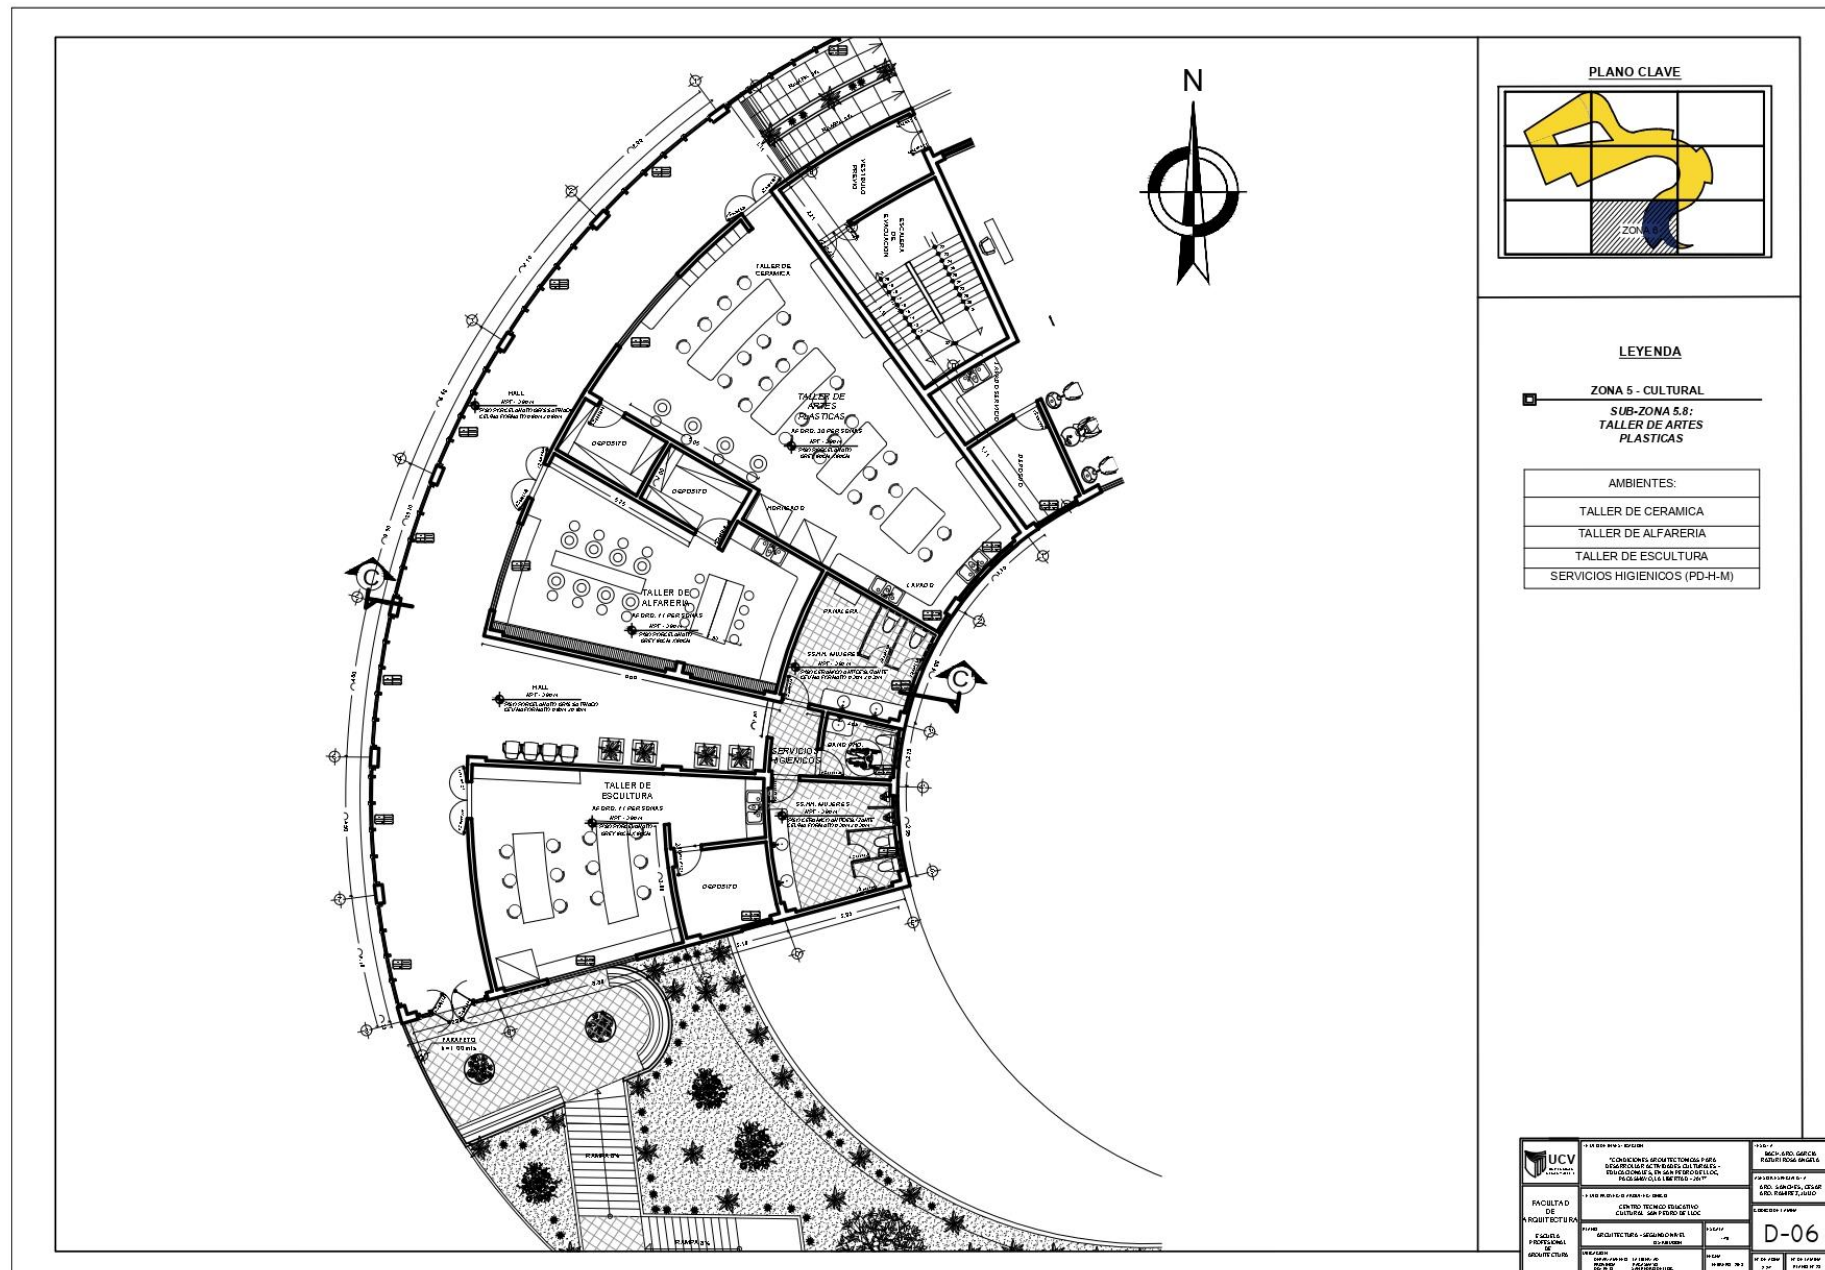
Plano de Desarrollo por Zonas - Plano N° 23 - Lamina N°: D - 06
